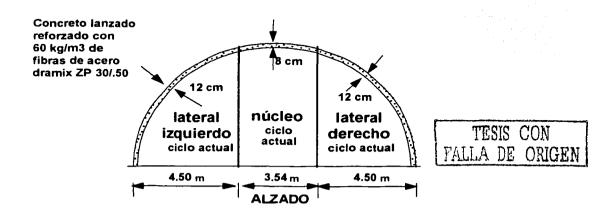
aplicación de concreto lanzado en las zonas recién excavadas.
